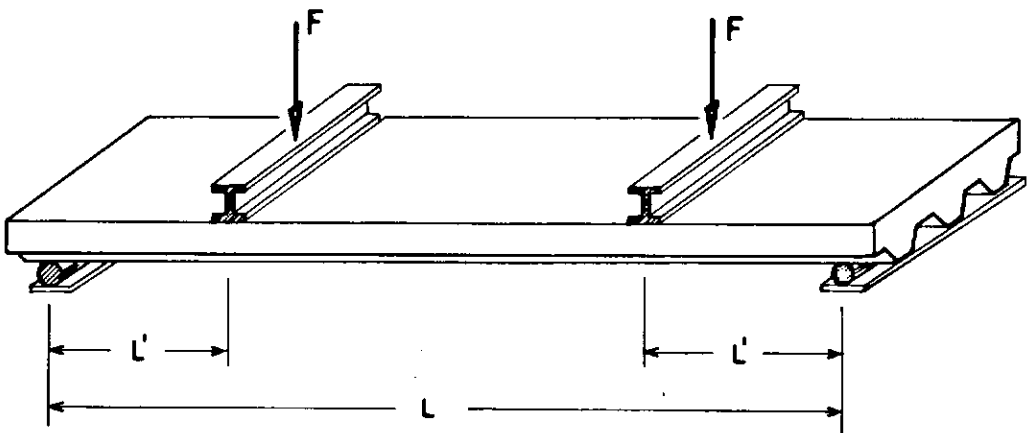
Esquema de ensaio tipo viga em lajes compostas.
